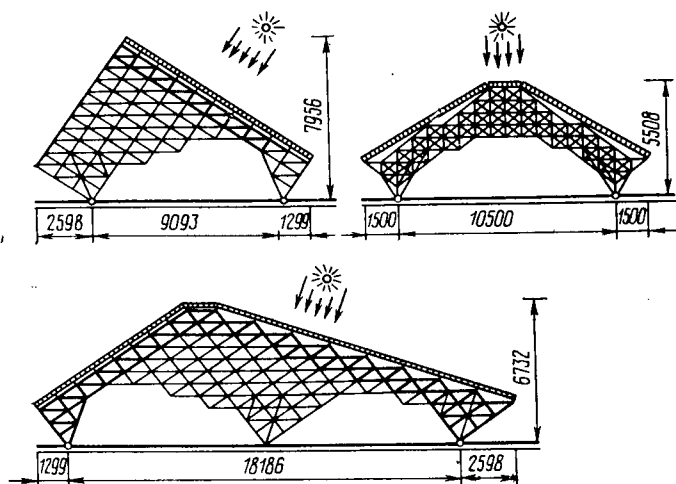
Перекрестно-стержневые конструкции покрытий общественных зданий
